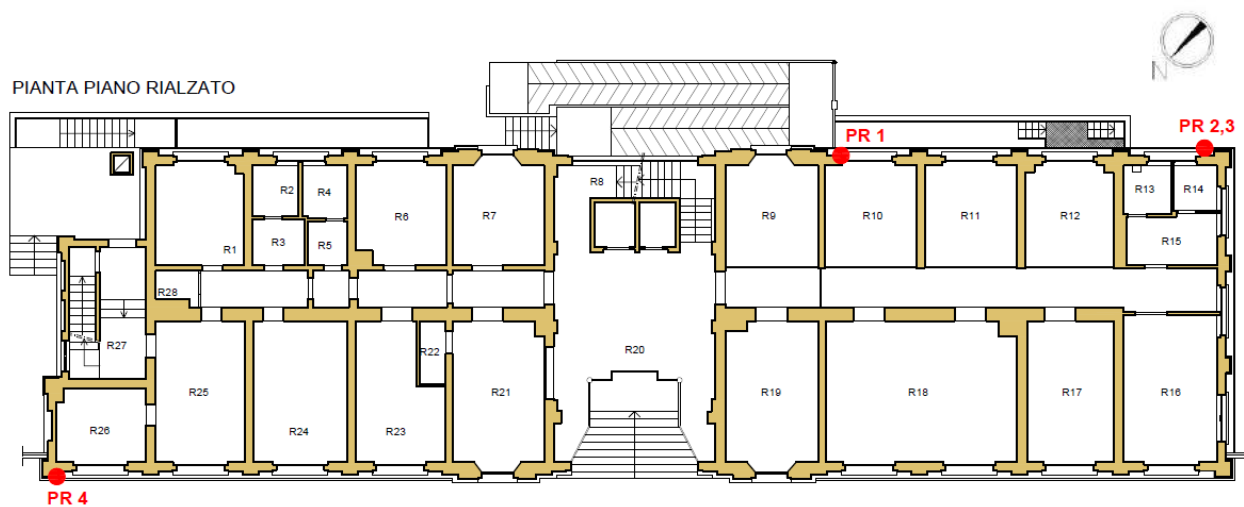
pianta del piano rialzato con indicate in rosso le zone dove sono stati prelevati i campioni.
